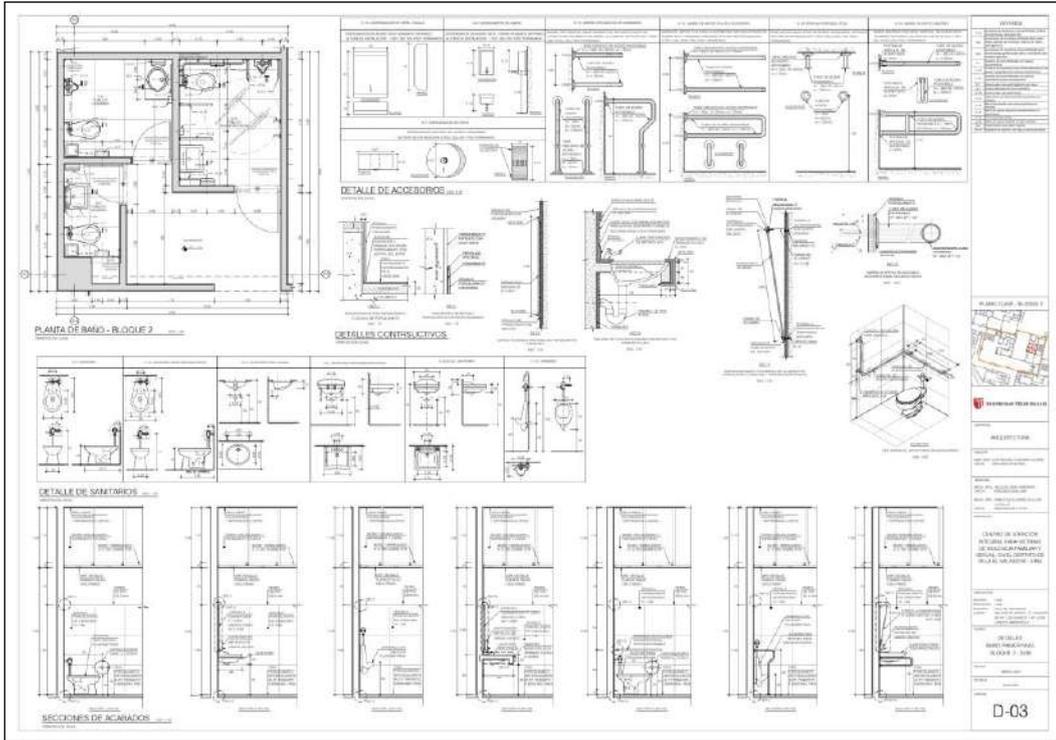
Detalles en baños de zona SUM primer nivel – bloque 2.
